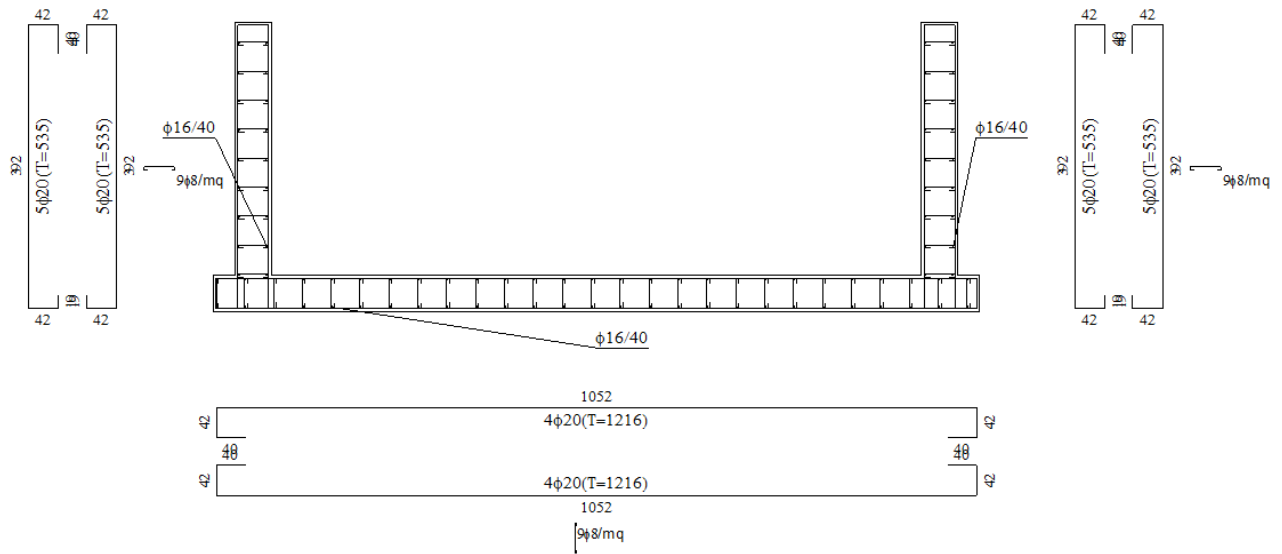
Schema delle armature, sezione tipo della soglia di regolazione
